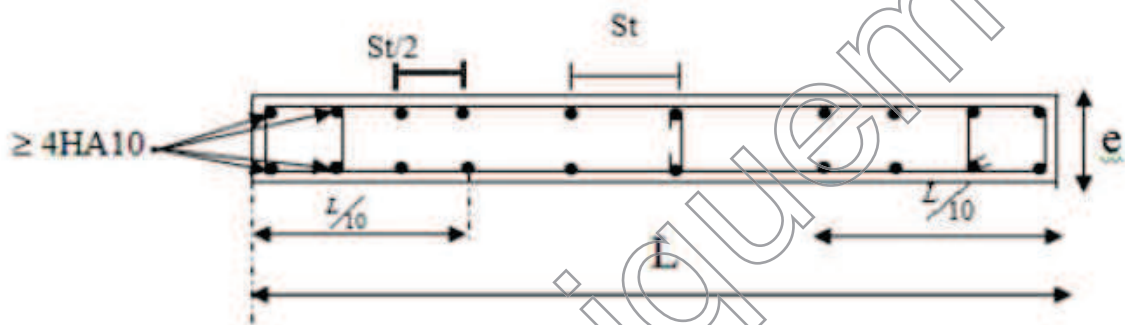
Disposition des armatures verticales dans les voiles.
